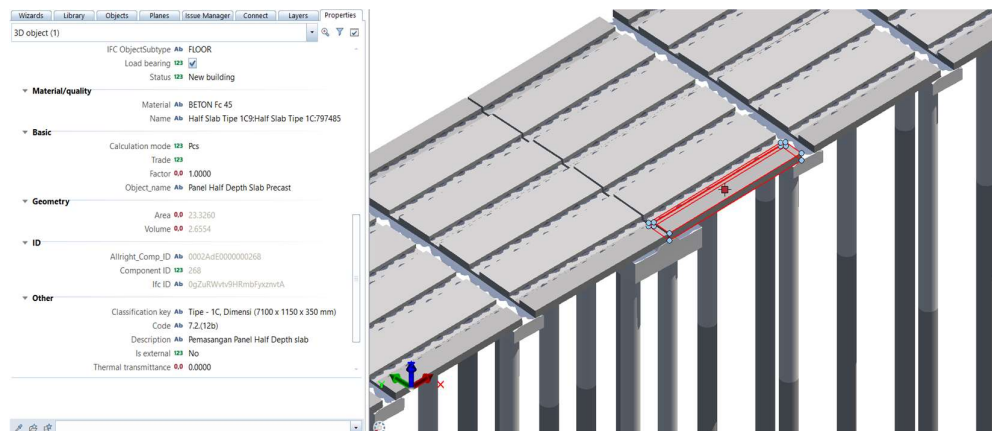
Quantity Take Off Beton Half Slab Precast Tipe 1A
